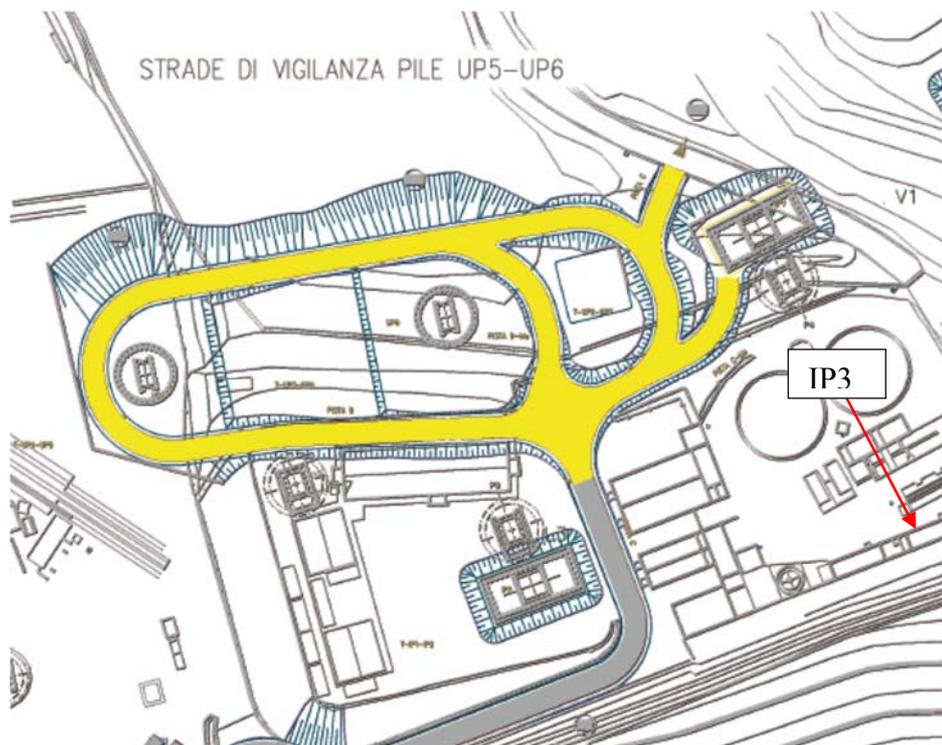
Stralcio planimetrico Strada di vigilanza Pile UP5 – UP6
